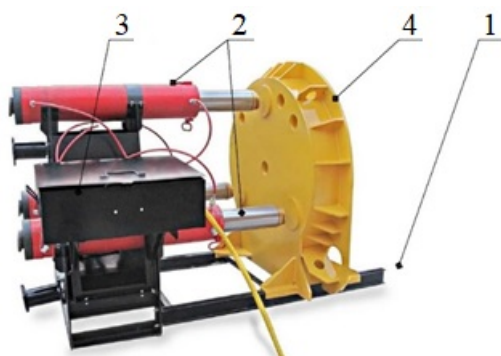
Загальний вид установки для протискування труб: 1 – упорна плита; 2 – гідроциліндри; 3 – пульт керування; 4 – рама, що спрямовує
